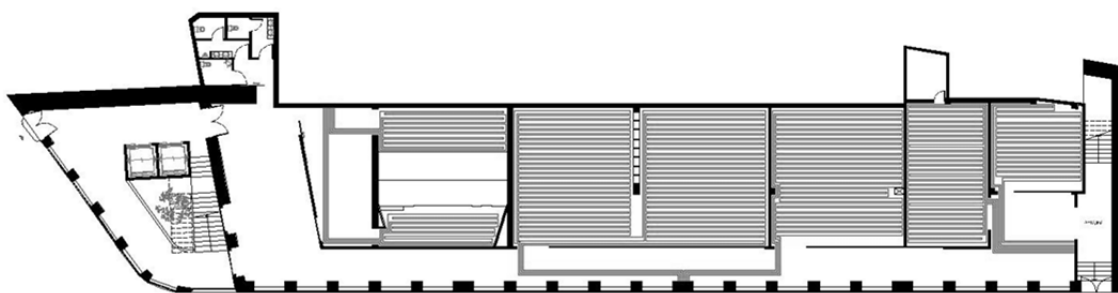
Planta de distribuição do Piso Radiante, Piso 1
